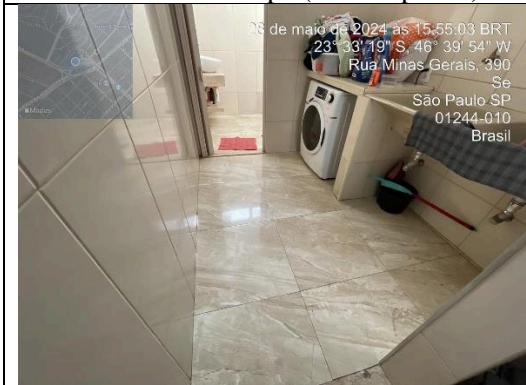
Vista 2 / Lavanderia (Pav. Superior)
